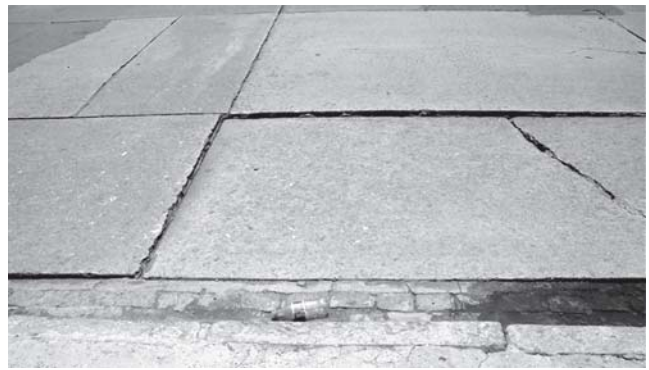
Vista parcial do pavimento deteriorado da Av. Conde da Boa Vista
